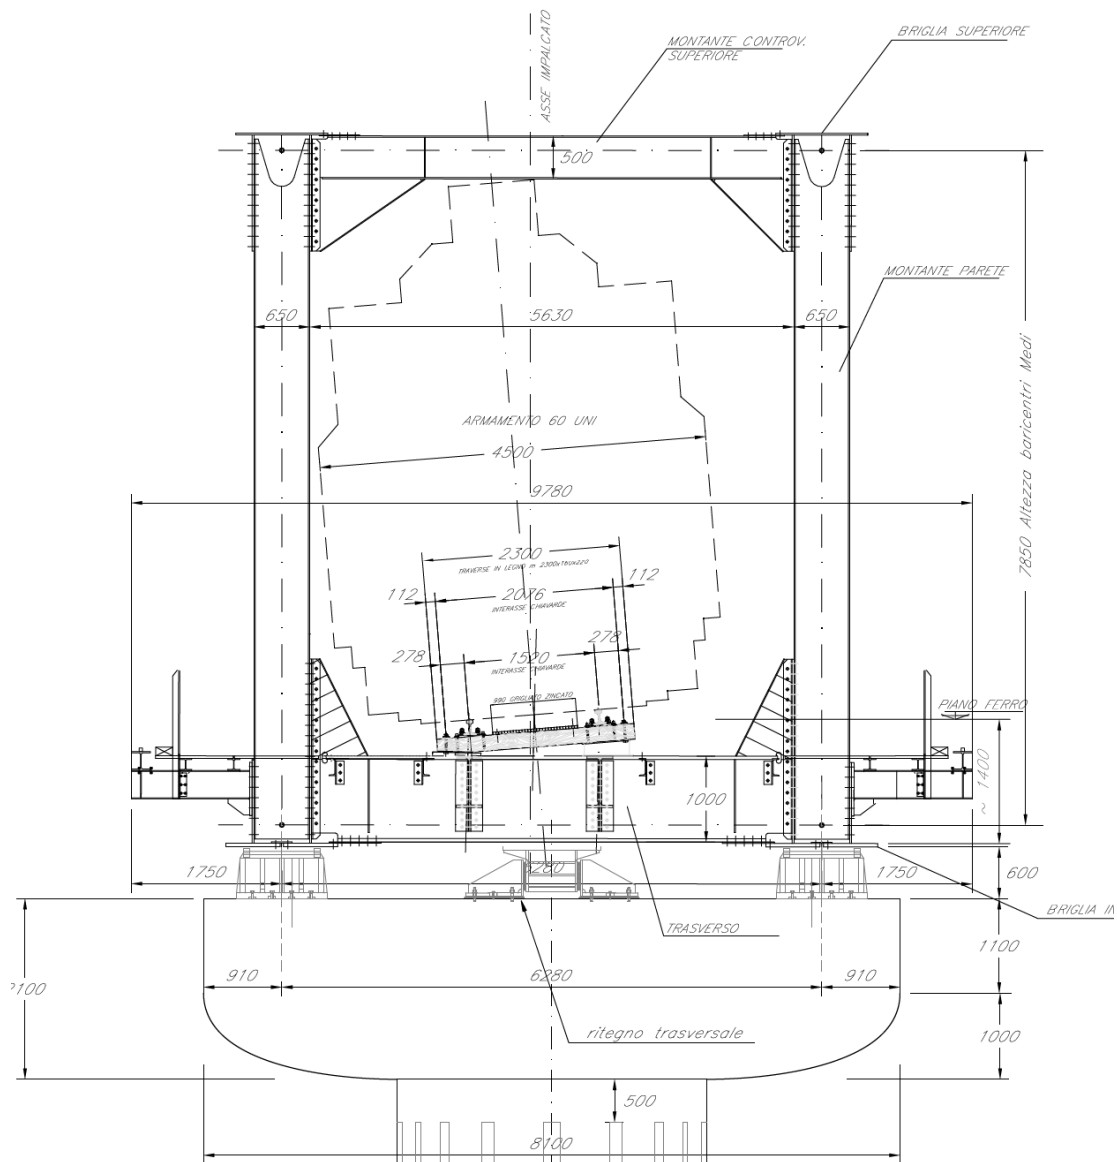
Sezione impalcato reticolare 60m , viadotto VI13 Nuovo Basento
